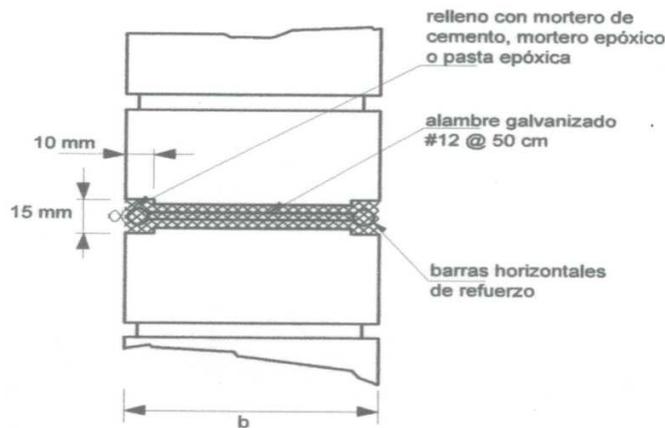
Ejemplo de inserción de barras de refuerzo en las juntas de un muro
